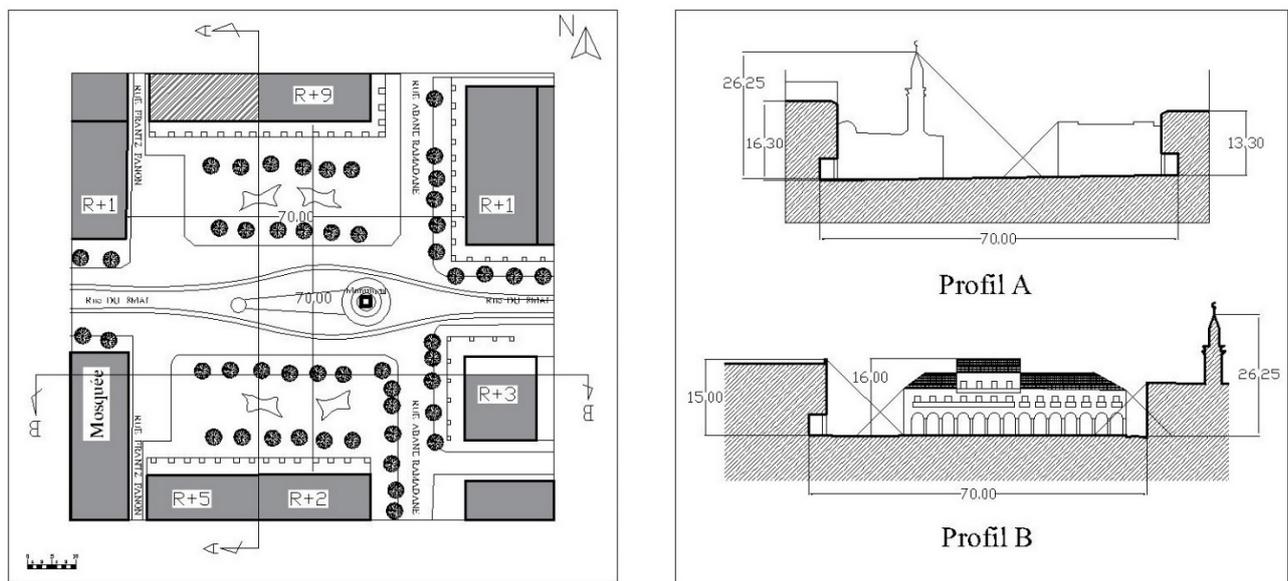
Plan et profil en long et en travers montrant l'organisation et gabarit autour de la place Sahat El Istiklal. Source : d'après les relevés et dessins de l'auteur.
